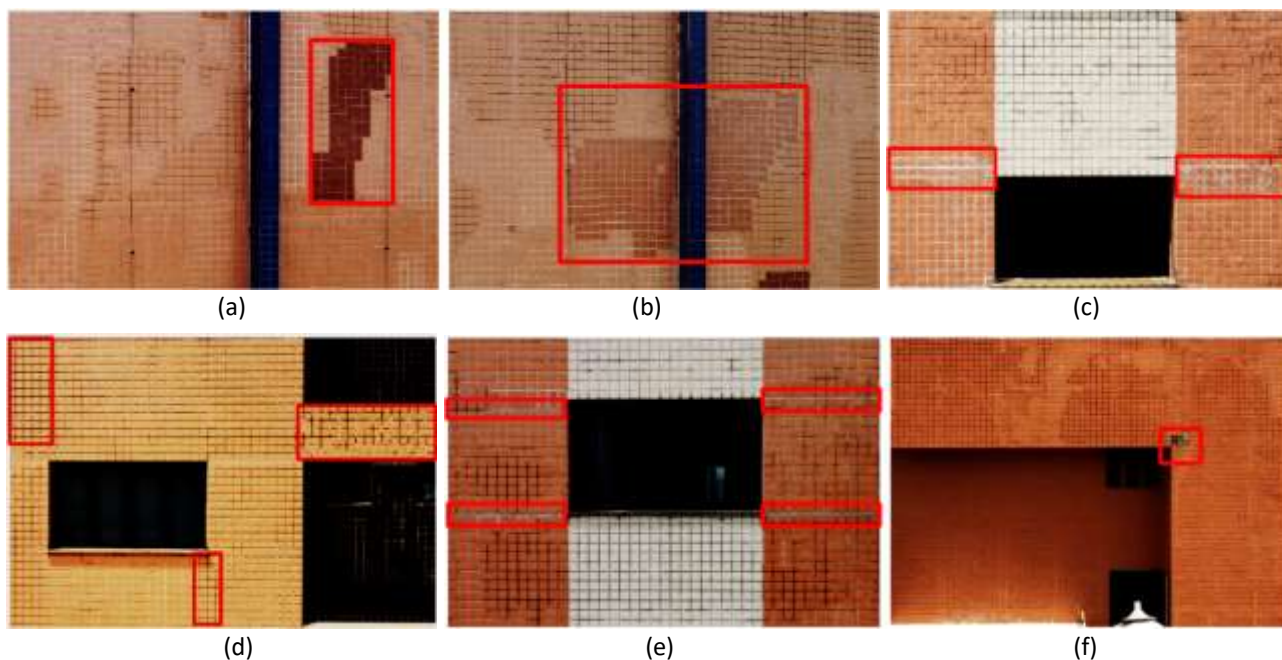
Inspeção prévia em fachadas: Placas cerâmicas substituídas (a e b); Zonas com eflorescência (c); Zonas com desgaste excessivo do rejunte (d); Seções com deterioração do selante elastomérico das juntas de movimentação horizontal (e); Descolamento das peças cerâmicas (f)
